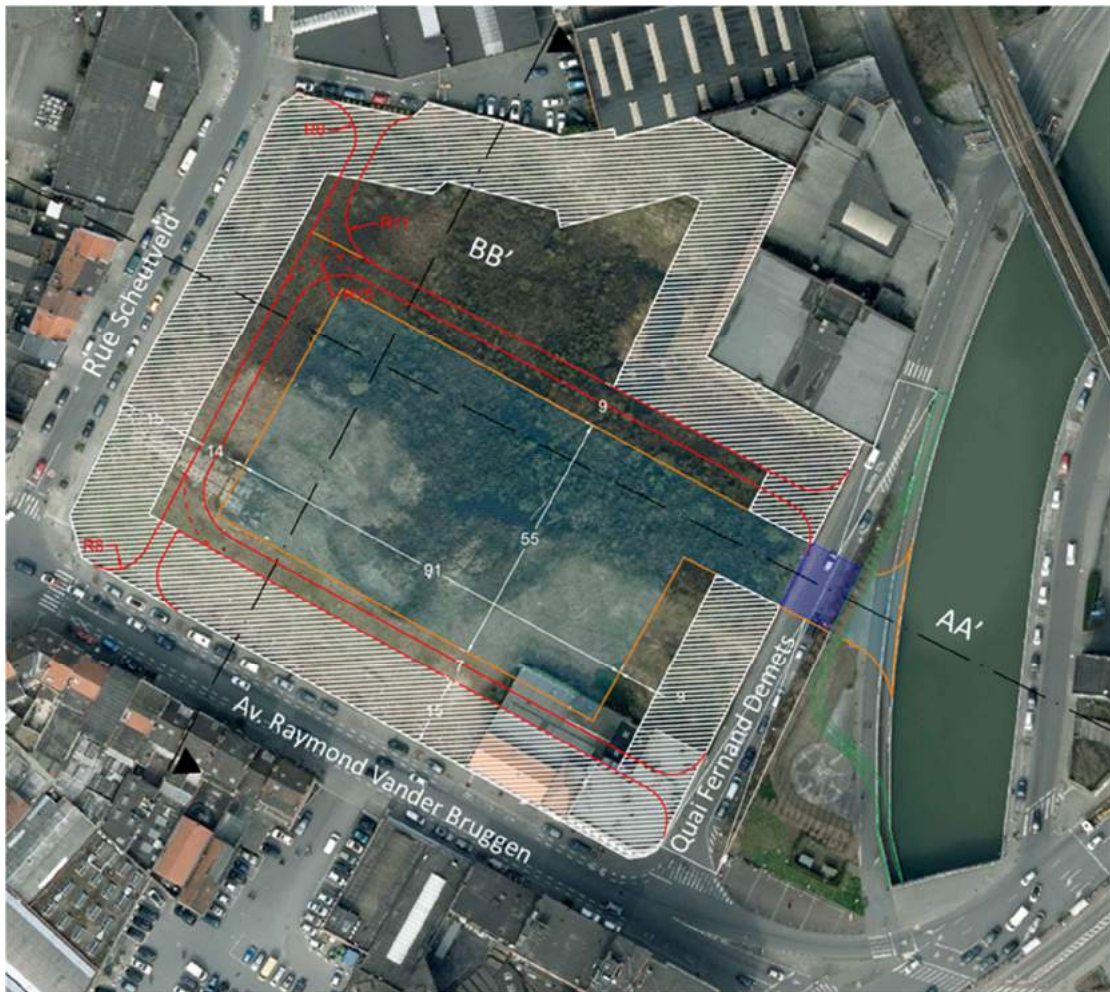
Plan indicatif de la position d'un bassin sur l'îlot Shell (ARIES, 2017)
